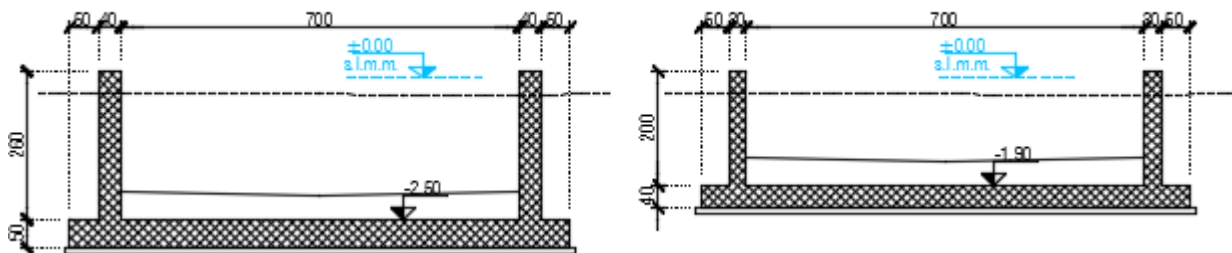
sezioni trasversali B-B e C-C muri di imbocco
